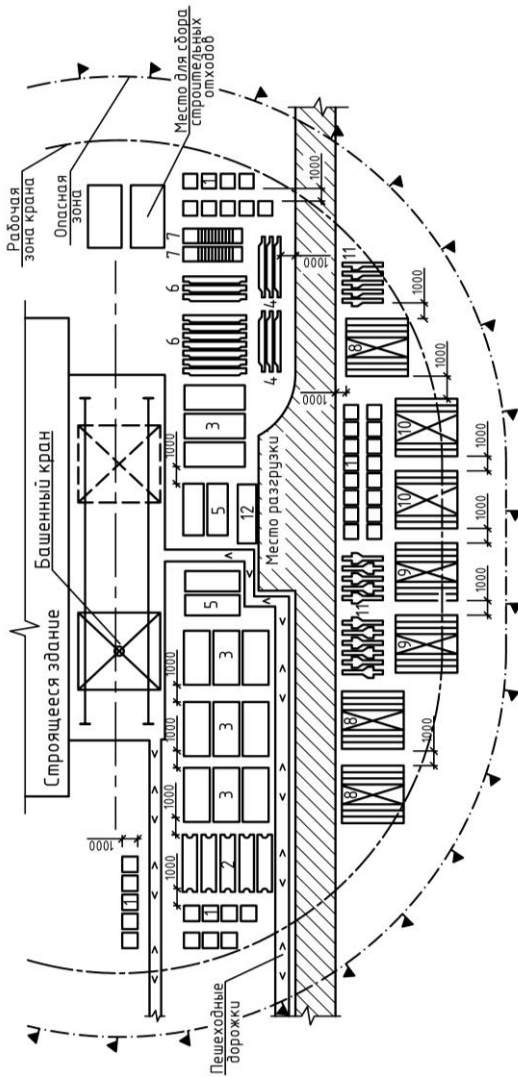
Примерный план размещения грузов на приобретённом складе: 1 – кирпич на поддонах; 2 – распорные плиты перекрытия (h до 2,5 м); 3 – пролетные плиты перекрытия (h до 2,5 м); 4 – распорные плиты крайние (h до 2,5 м); 5 – стены жесткости (h до 2,5 м); 6 – ригели (h до 2 м); 7 – лестничные марши (h до 2 м); 8 – стеновые панели в пирамиде (h до 2 м); 9 – витражи в пирамиде; 10 – перегородки в пирамиде с укрытием от атмосферных осадков; 11 – колонны (h до 2 м); 12 – площадка для кантовки конструкций
